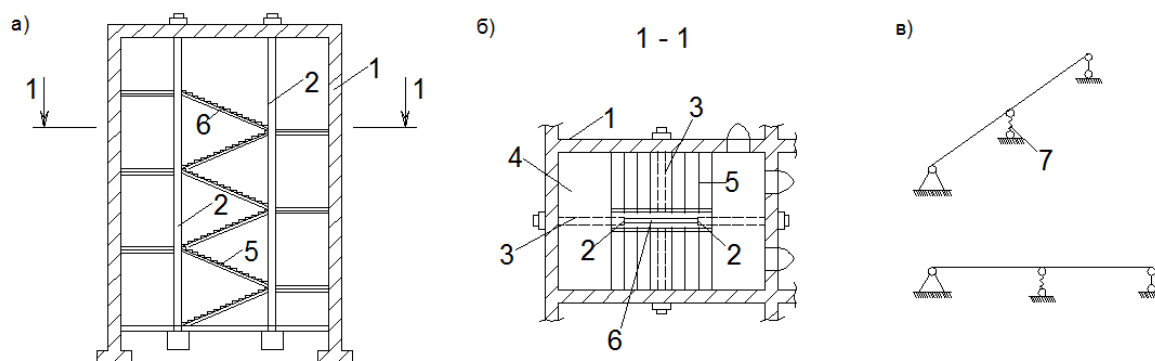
Сейсмоусиление лестничной клетки решетчатой диафрагмой жесткости. а - общий вид разреза усиленной лестничной клетки; б - план лестничной клетки по 1-1; в - расчетные схемы лестничных маршей и площадок; 1 – стена клетки; 2 – стойки усиления; 3 – анкерные тяги; 4 – площадка; 5 – лестницы; 6 – раскос фермы; 7 – упругие опоры
